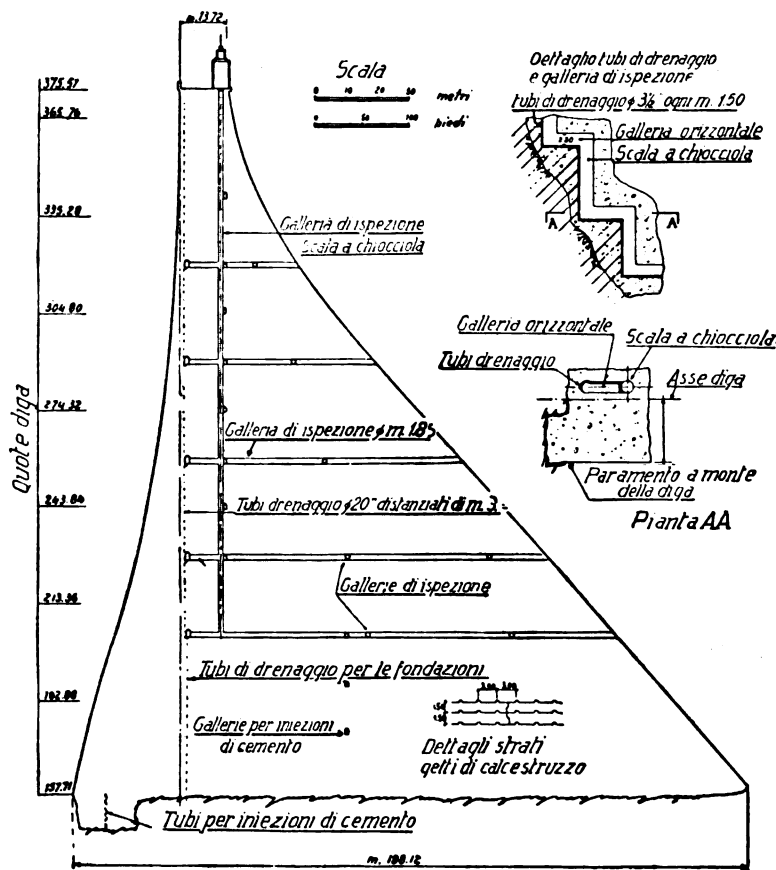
Sezione trasversale della diga e particolari dei dispositivi di drenaggio.
